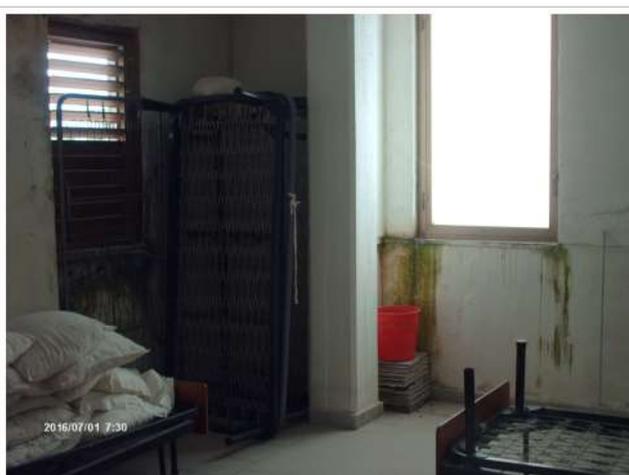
LOCALE SENZA TITOLO AUTORIZZATIVO
